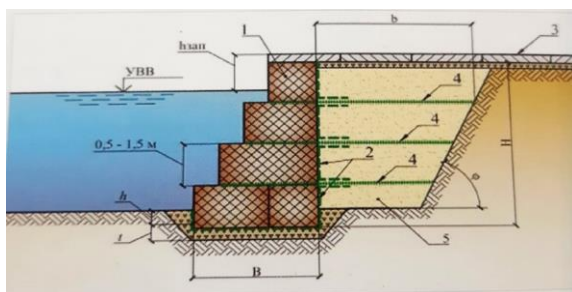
Укрепление размываемого берега с помощью габионных конструкций с армированием грунта:
